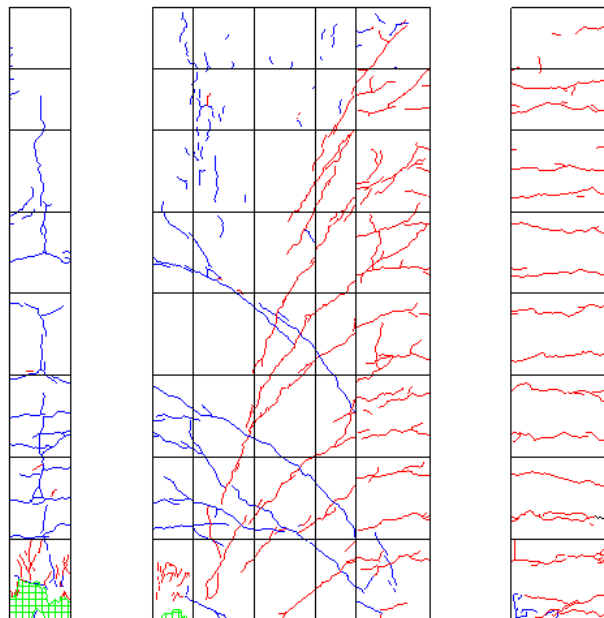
R=1/50②ひび割れ図
